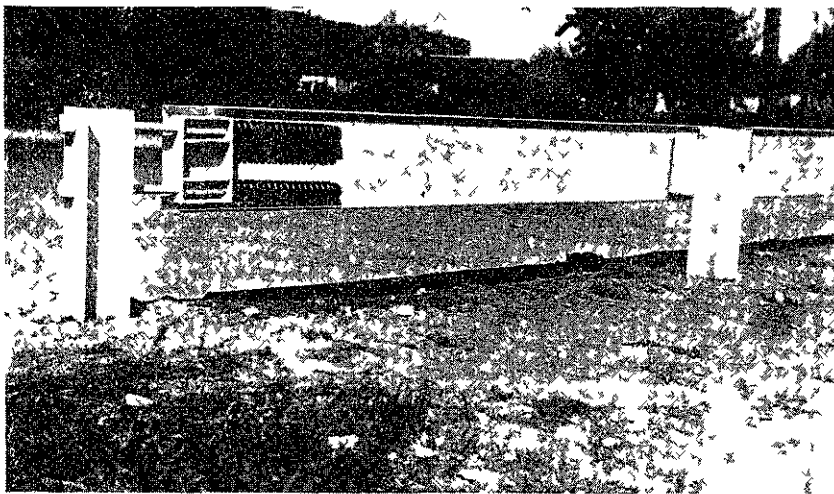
, — Ressorts de fixation assurant la liaison elastique entre le parapet et les poteaux
